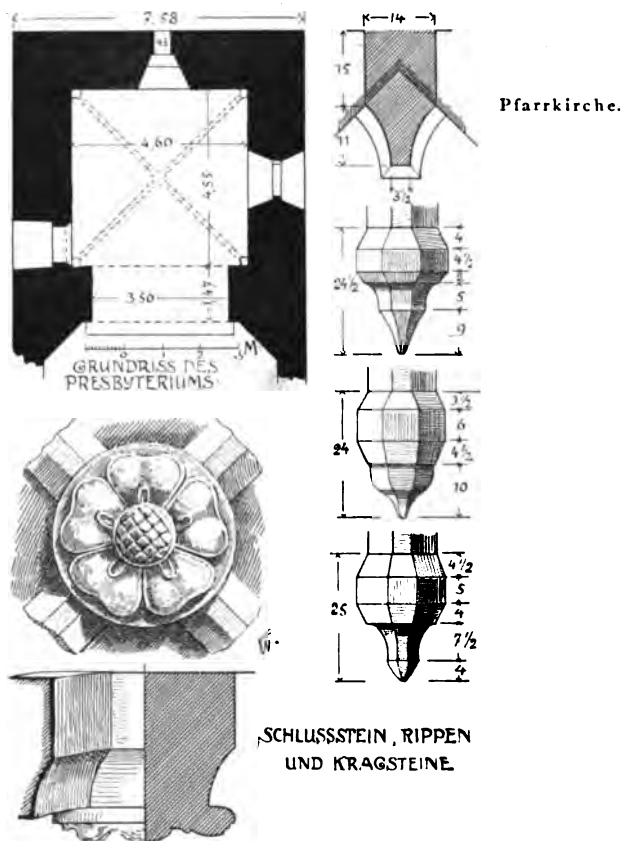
Pielenhofen. Grundriß und Details vom Chor der Pfarrkirche.
